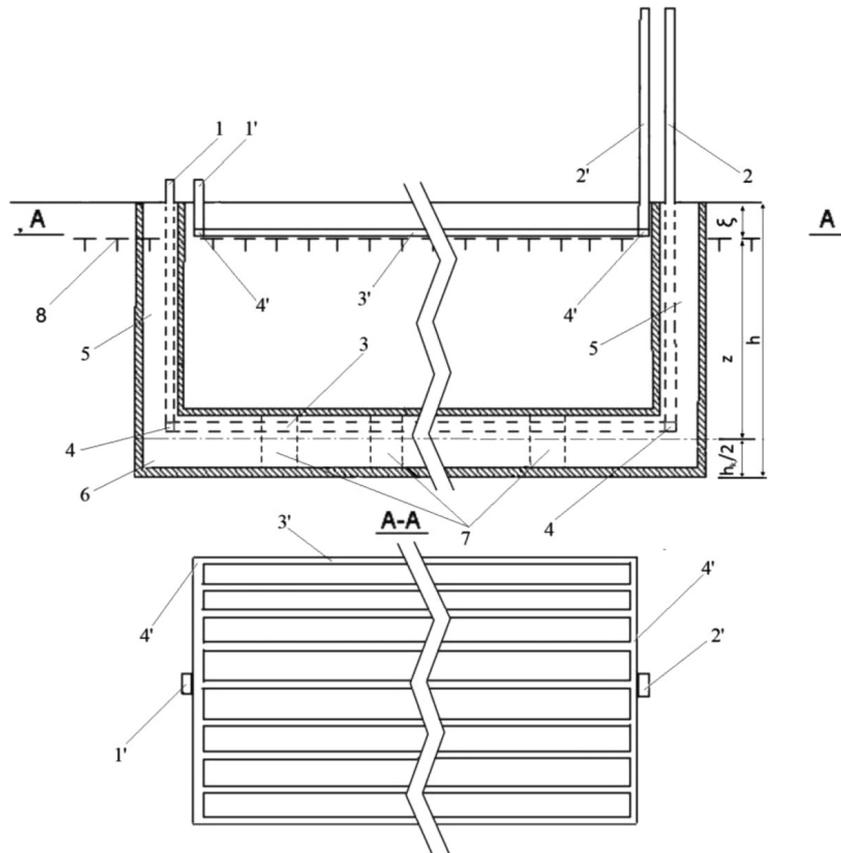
Схема воздушных охлаждающих установок криохранилища: 1 – каналы для нисходящего потока воздуха; 2 – каналы для восходящего потока воздуха; 3 – охлаждающие каналы; 4 – коллекторы; 5 – вертикальные стволы; 6 – основное рабочее помещение; 7 – боковые рабочие помещения; 8 – граница сезонного оттаивания; цифры без штрихов относятся к ОУ-1, со штрихами к ОУ-2
